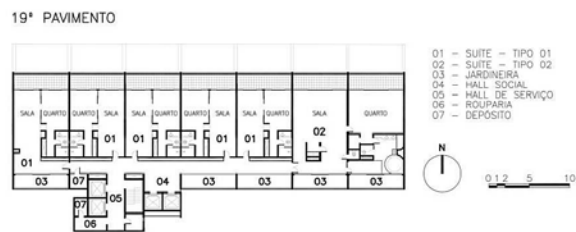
Planta 19º Pavimento. Fonte: Souza, 2015.
